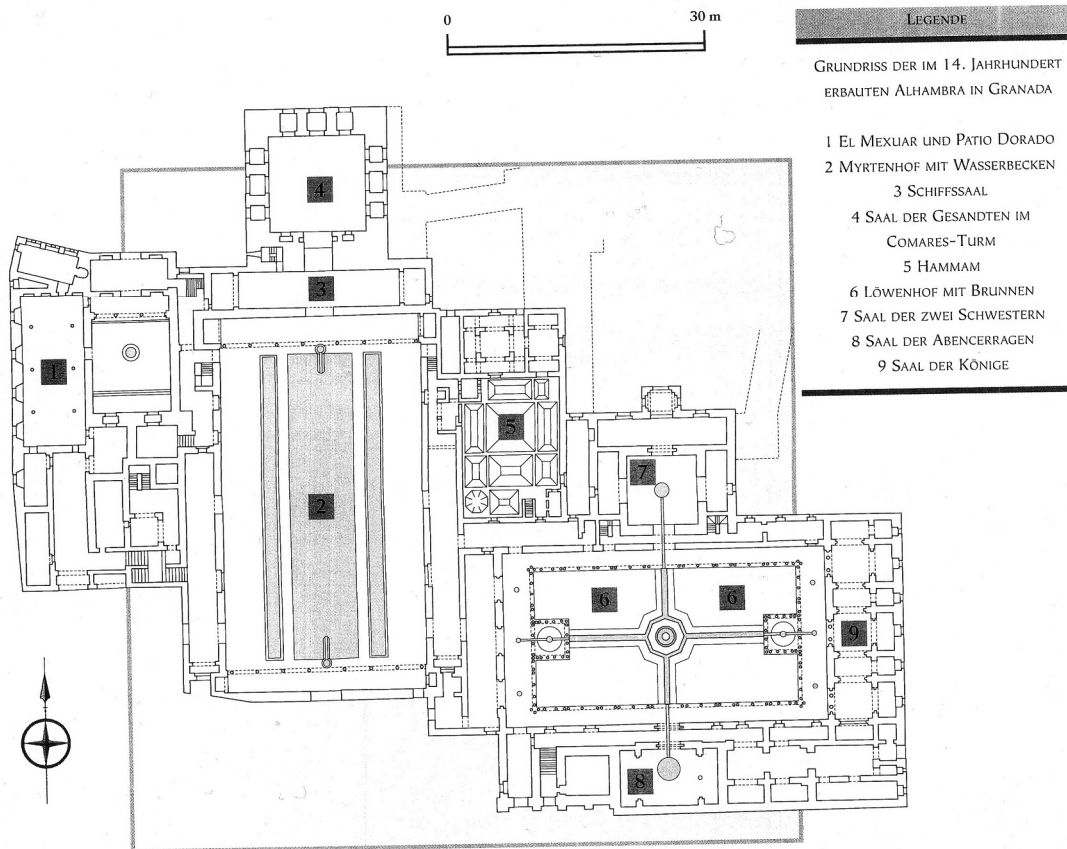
Grundriss des Comares- und des Löwenpalastes.
